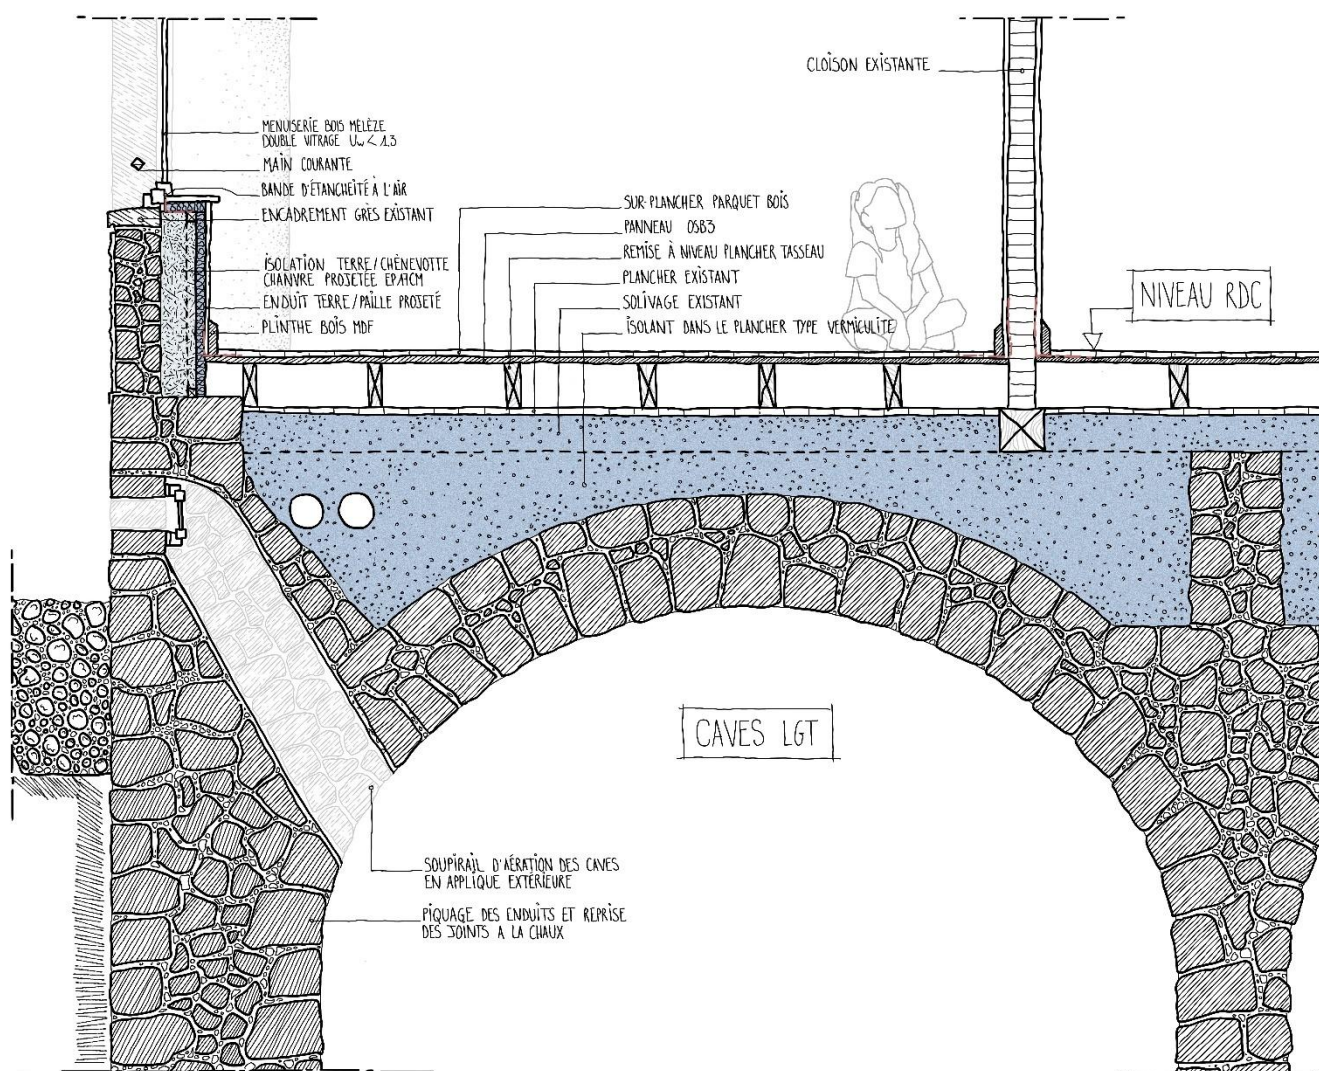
Croquis de la jonction de plancher bas sur voûte (source Mayker Architectes)
